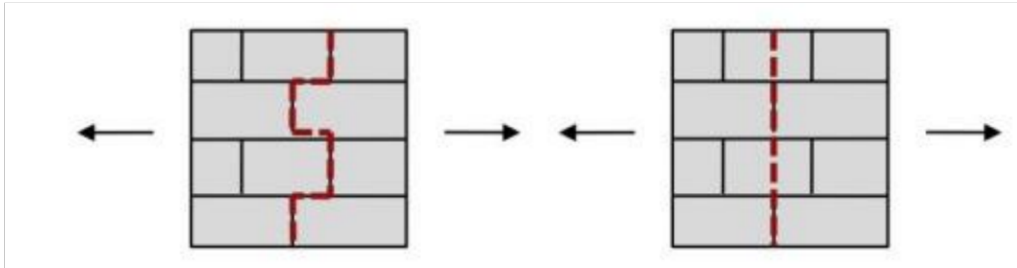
Agrietamiento de la mampostería bajo carga biaxial.
